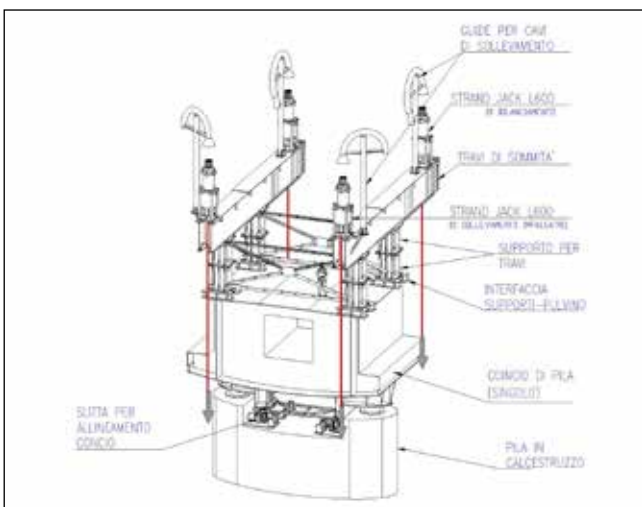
Strutture temporanee di supporto alla Macchina di Sollevamento "strand jack system"
